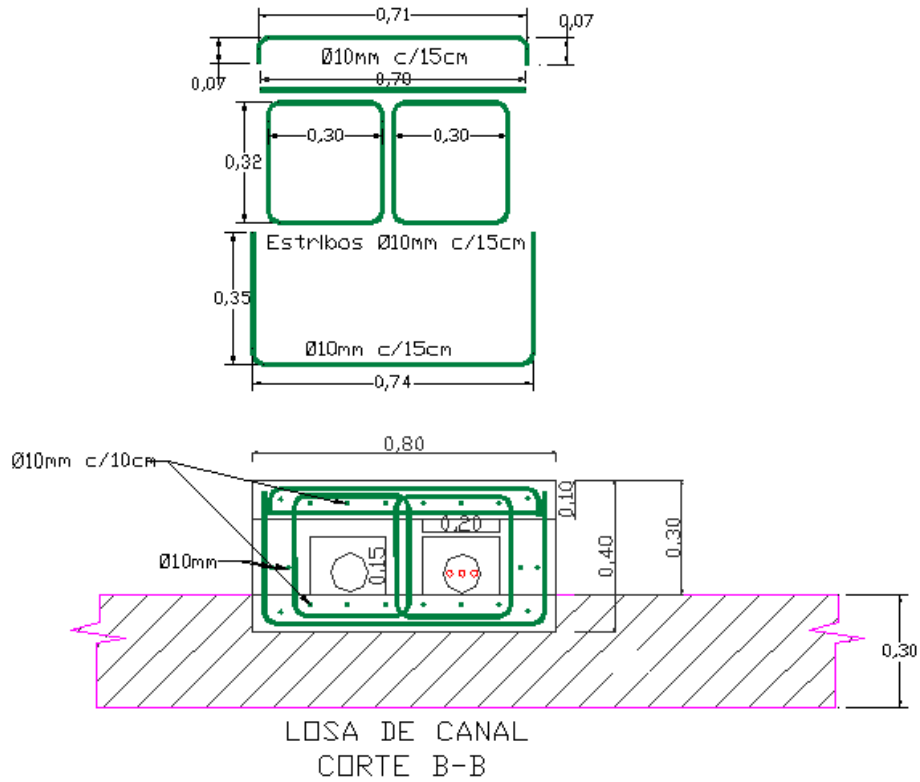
b: Detalle de viga de alojamiento. Armadura. Edet Av. Guzman.
